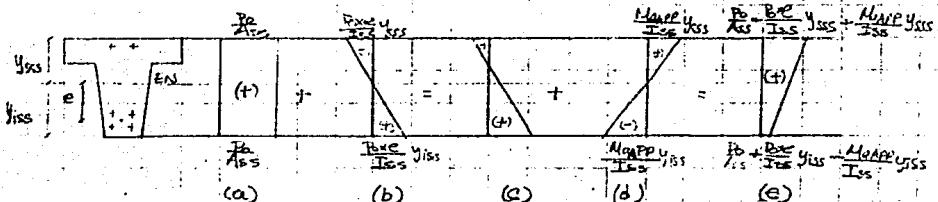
Diagrama de esfuerzos en una viga pretensada.
